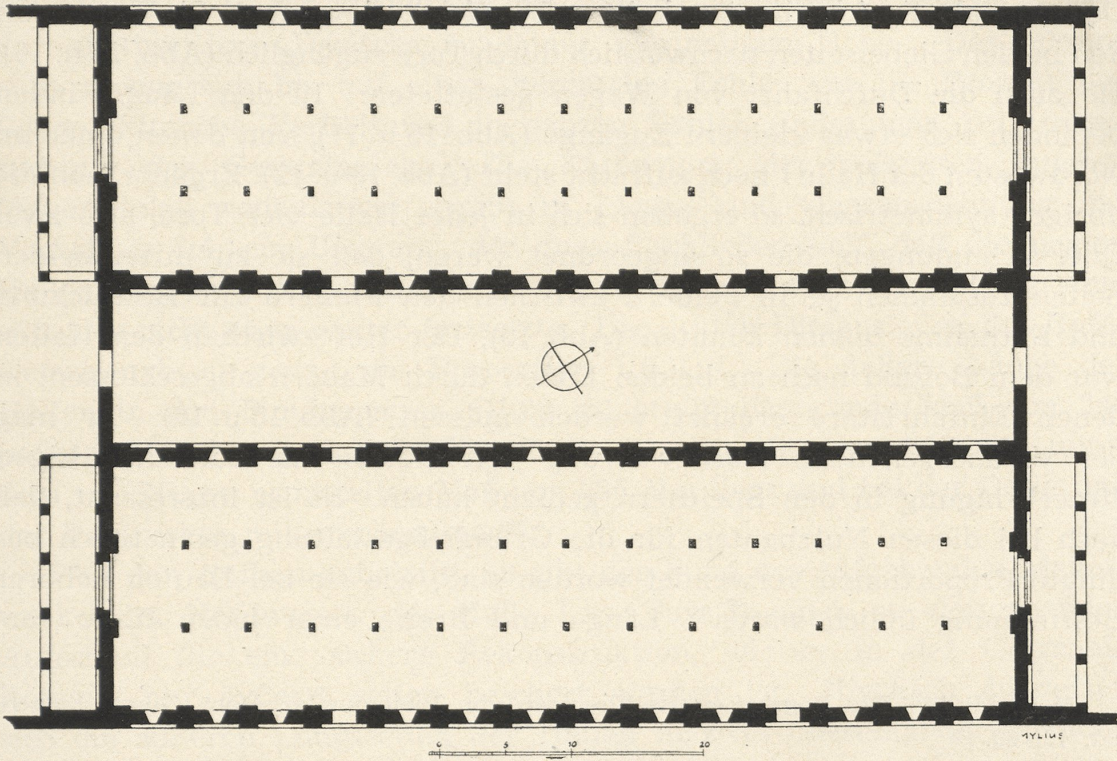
Horrea in Trier, Grundriß des Erdgeschosses;
